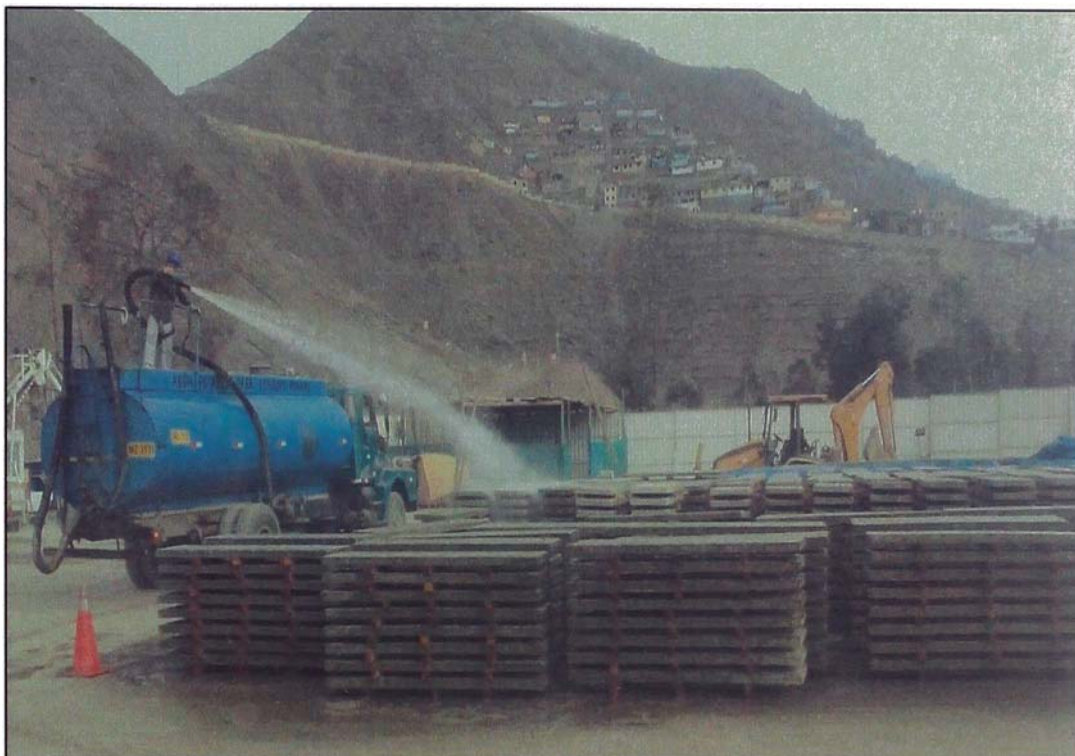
Fabricación de paneles – Curado de concreto con cisterna
